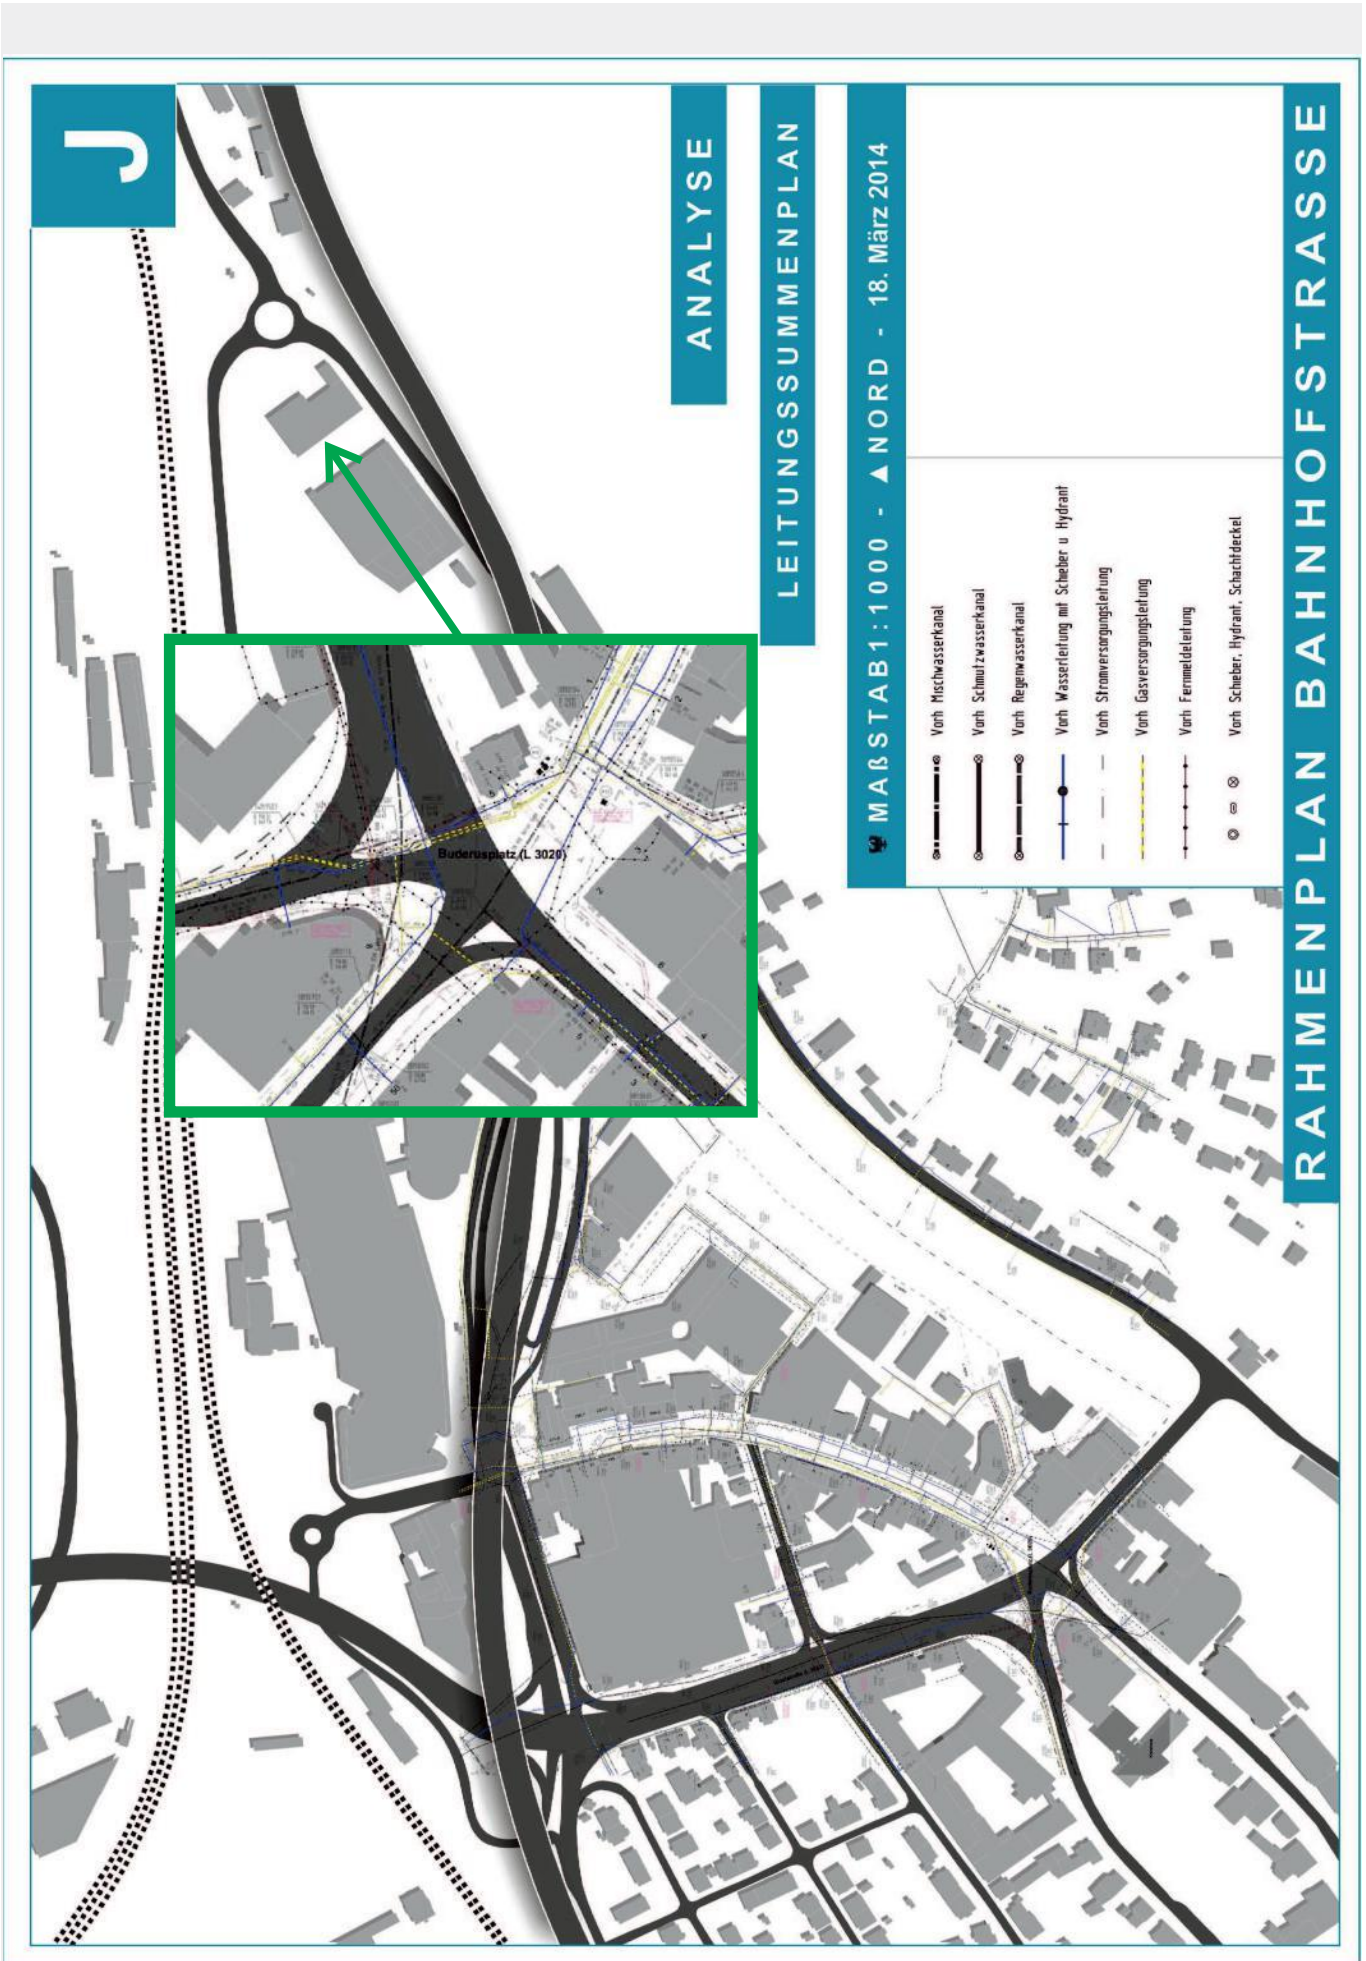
Analyseplan I - Leitungssummenplan - Abbildung verkleinert
